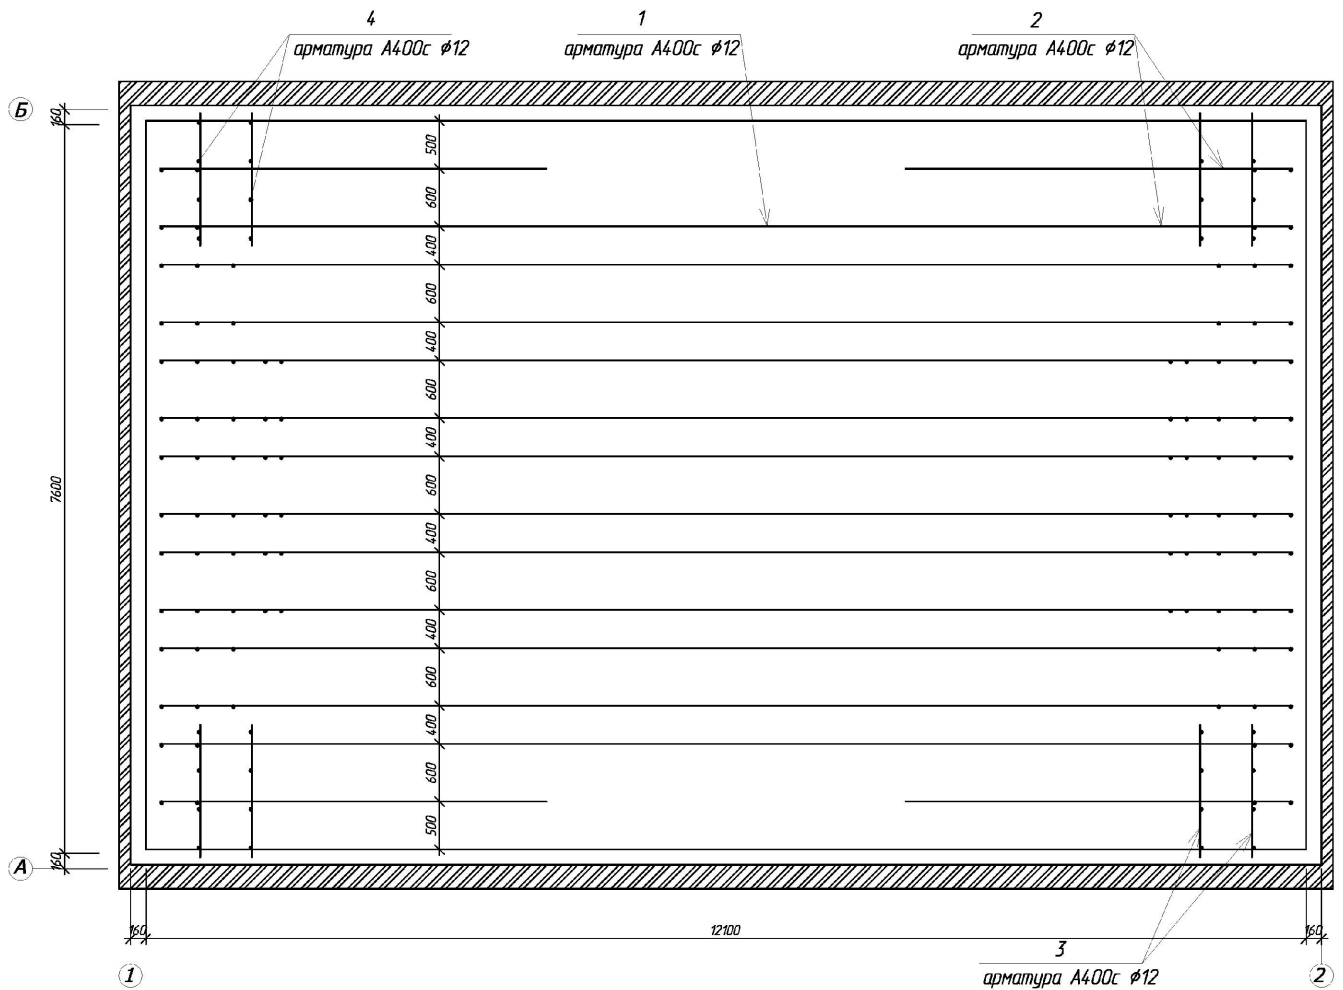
План розташування верхньої арматури та вертикальних стержнів.
